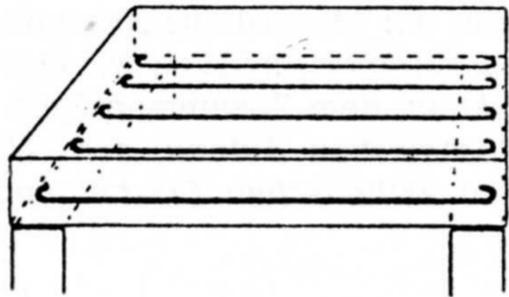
Schema der Stahlbewehrung einer Platte auf zwei Stützen.
